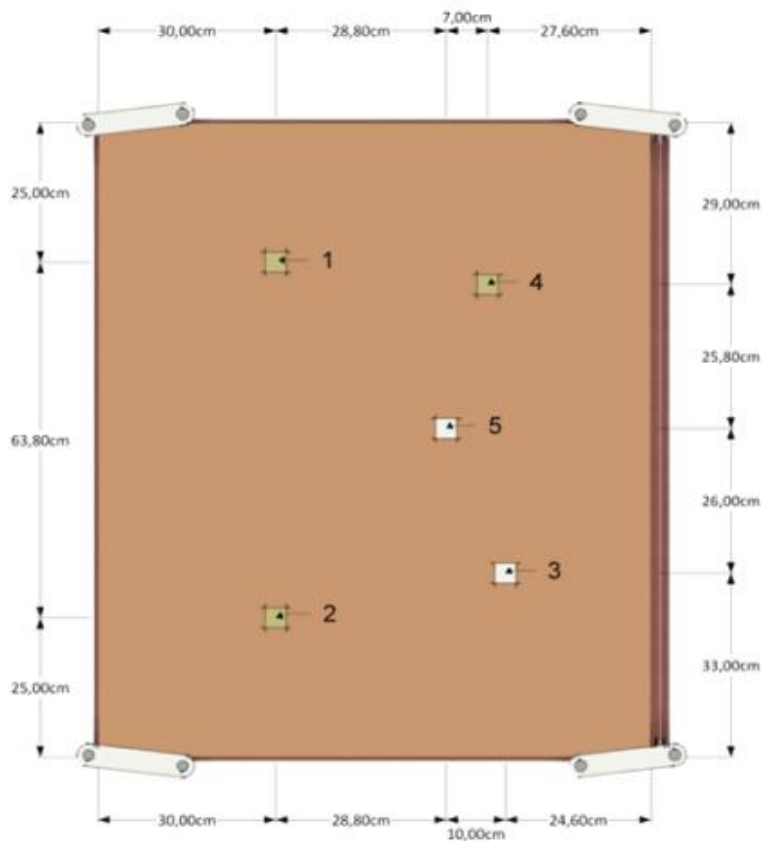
LOCAÇÃO DAS ESTACAS NA CAIXA DE AREIA DURANTE PRIMEIRA BATERIA DE ENSAIOS EM PLANTA BAIXA ESQUEMÁTICA
